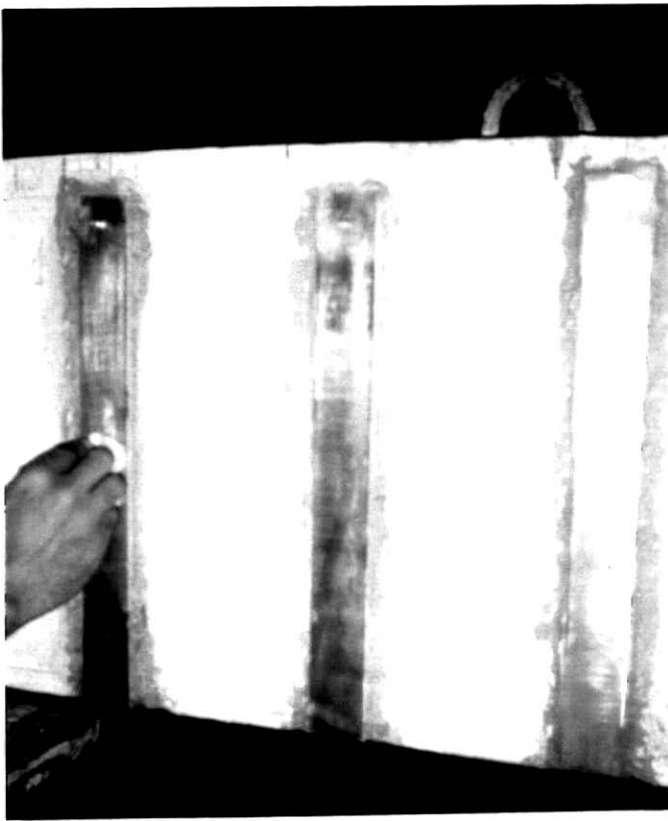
Limpeza da chapa antes da colagem da 2ª camada de estribo
